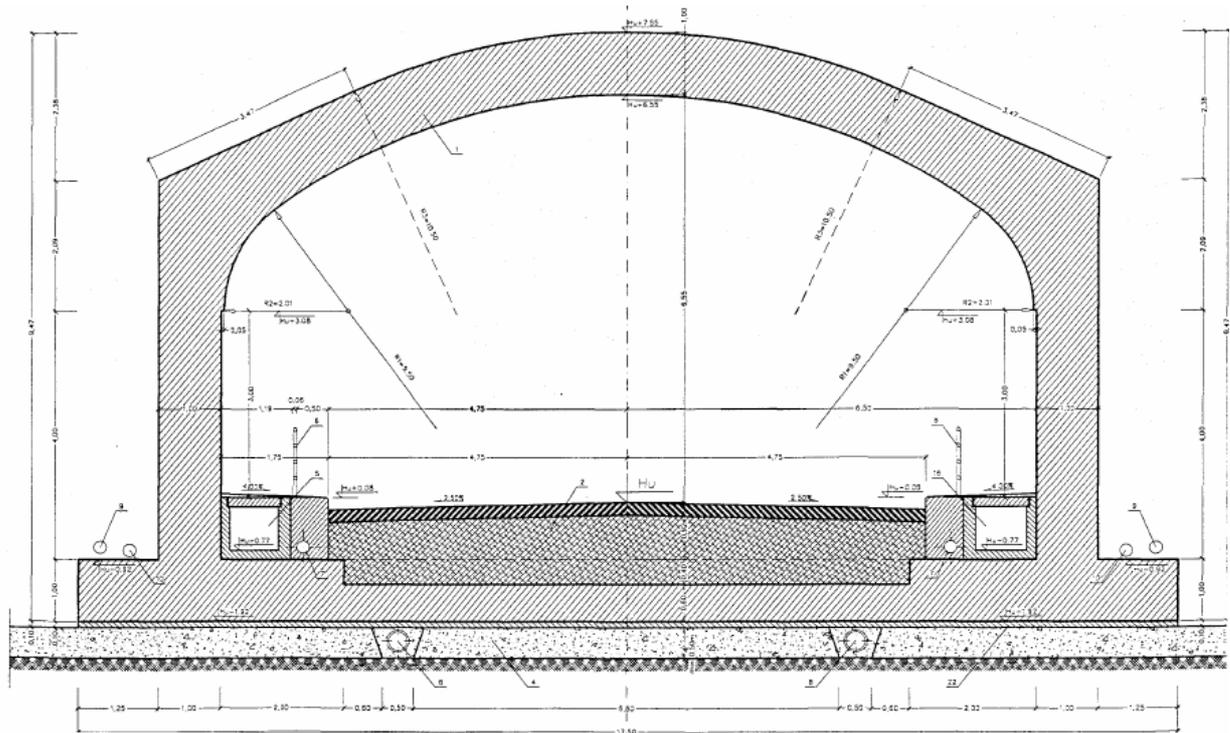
Querschnitt des Tunnels Gotze Delchev – Drama, Konstruktion mit einer Sohlplatte⁶⁷
